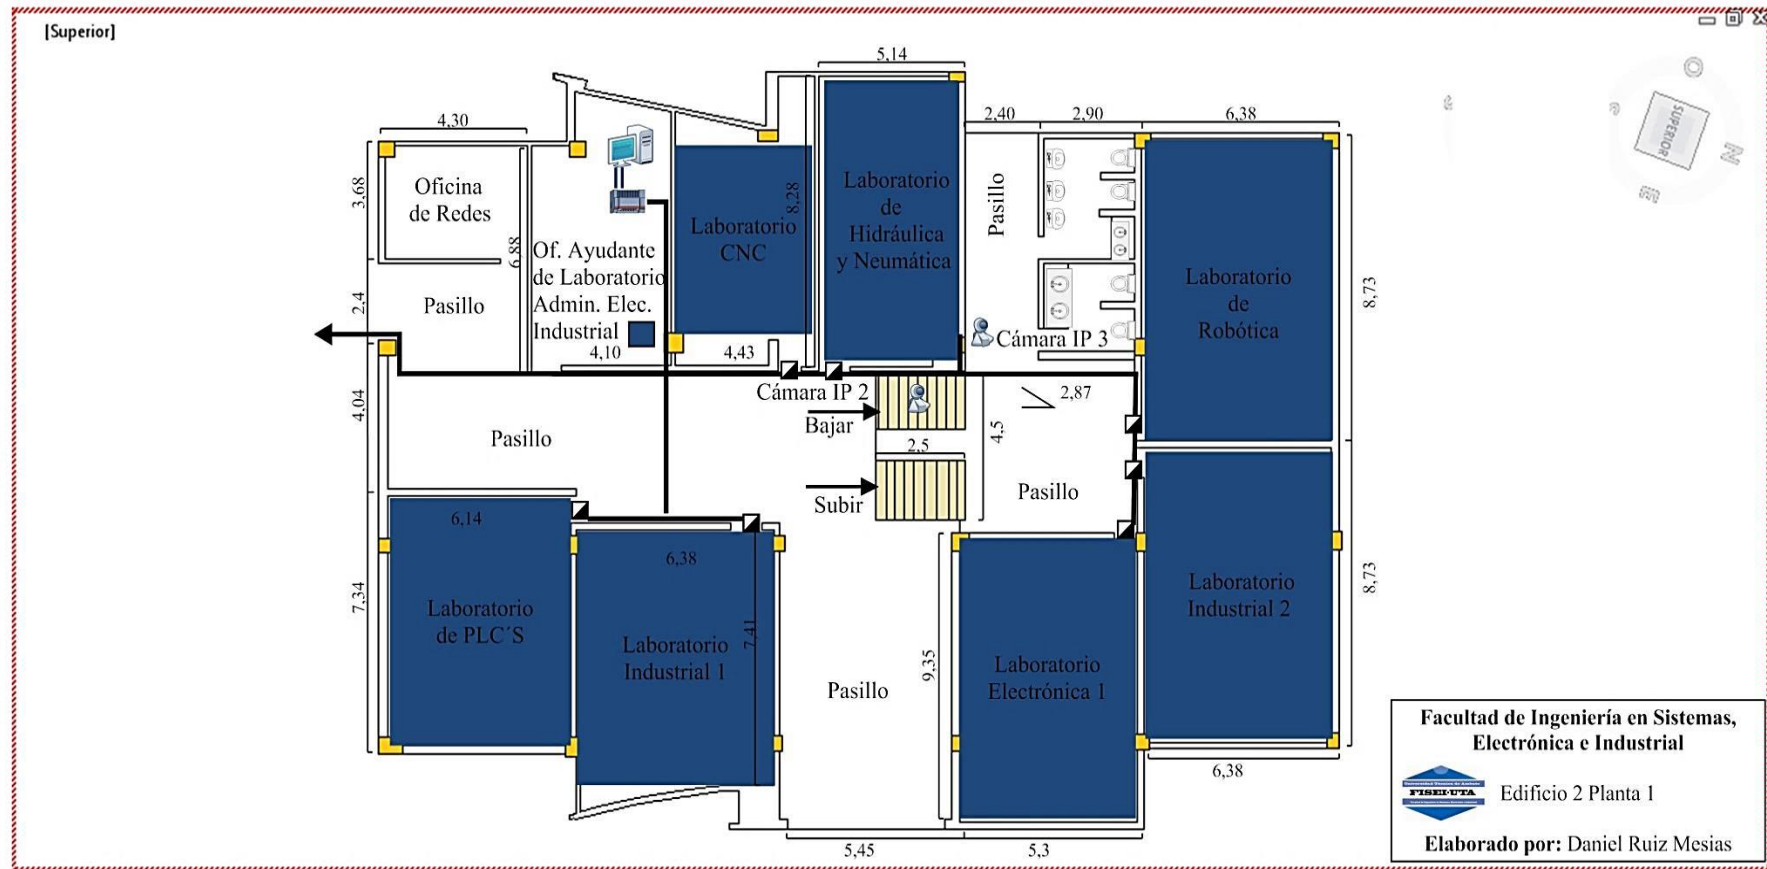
Distribución de elementos y cableado Edificio 2 Planta 1.
